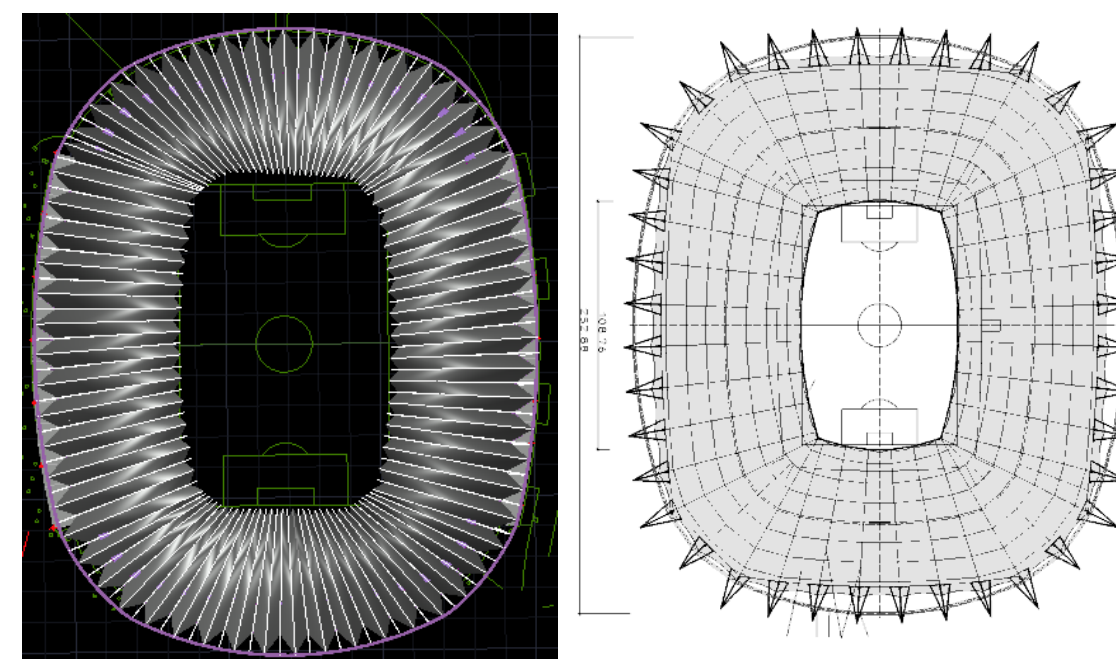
Semejanza entre la cubierta diseñada en este Anteproyecto y el AOL Arena de Hamburgo. Ambas con un anillo interior casi rectangular.
